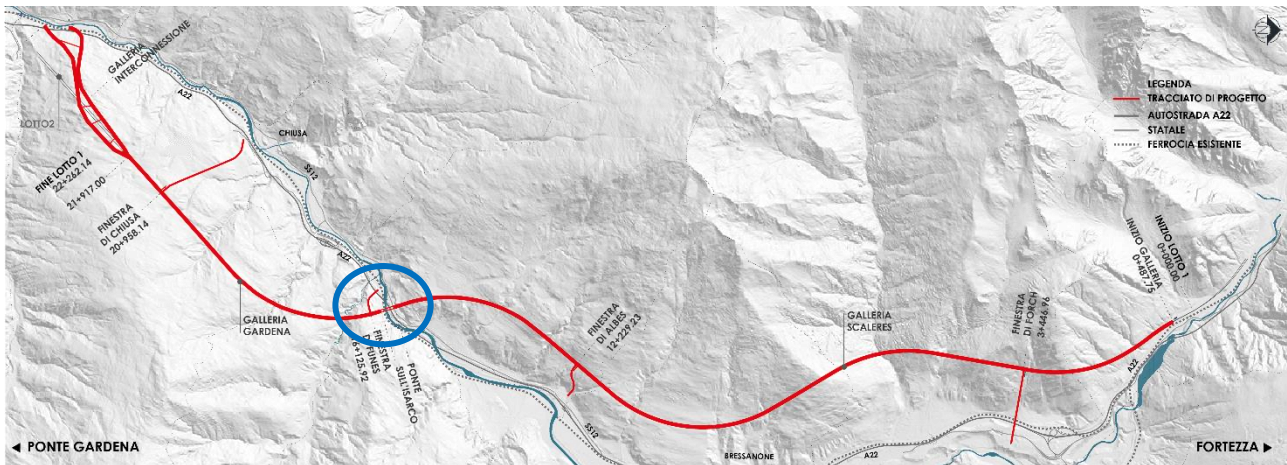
Tratta ferroviaria "Fortezza – Ponte Gardena"
